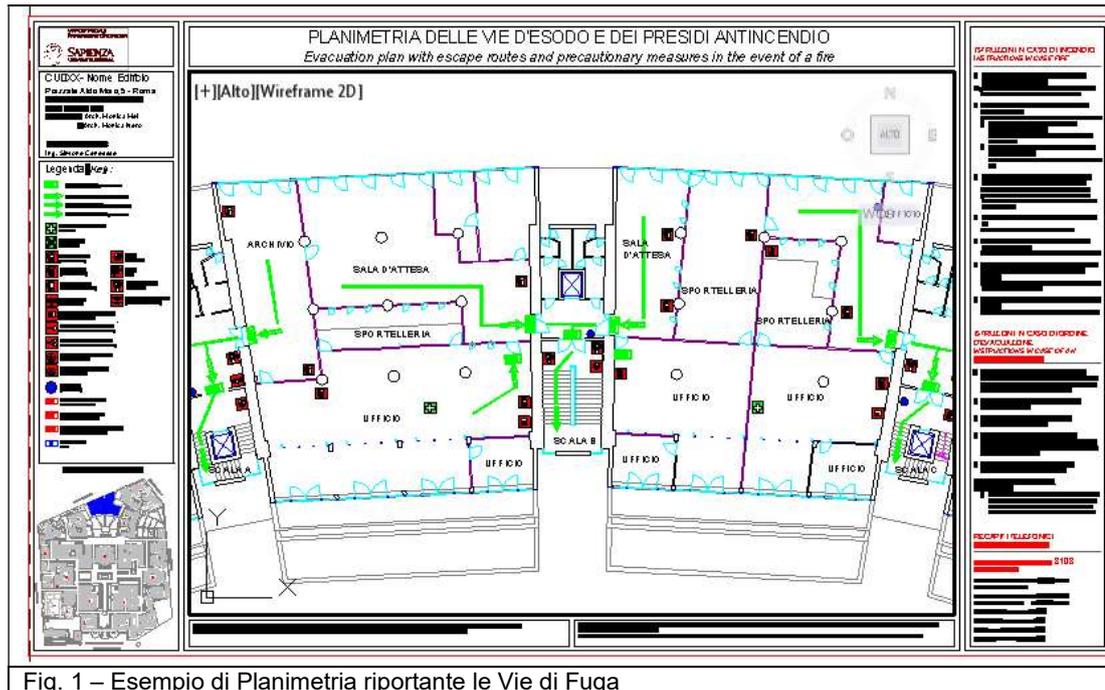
Esempio di Planimetria riportante le Vie di Fuga
